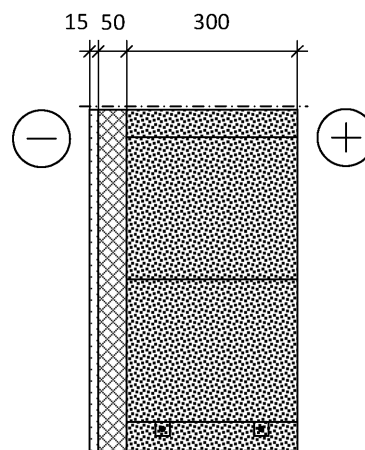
Стена из газобетона с использованием эффективного утеплителя
